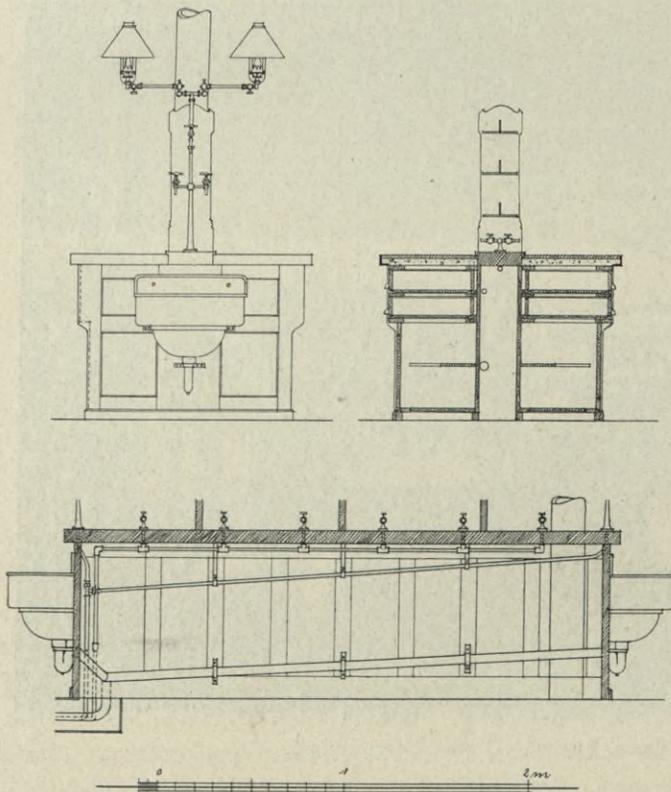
a. Seitenansicht und Schnitte zu Abb. 122.
